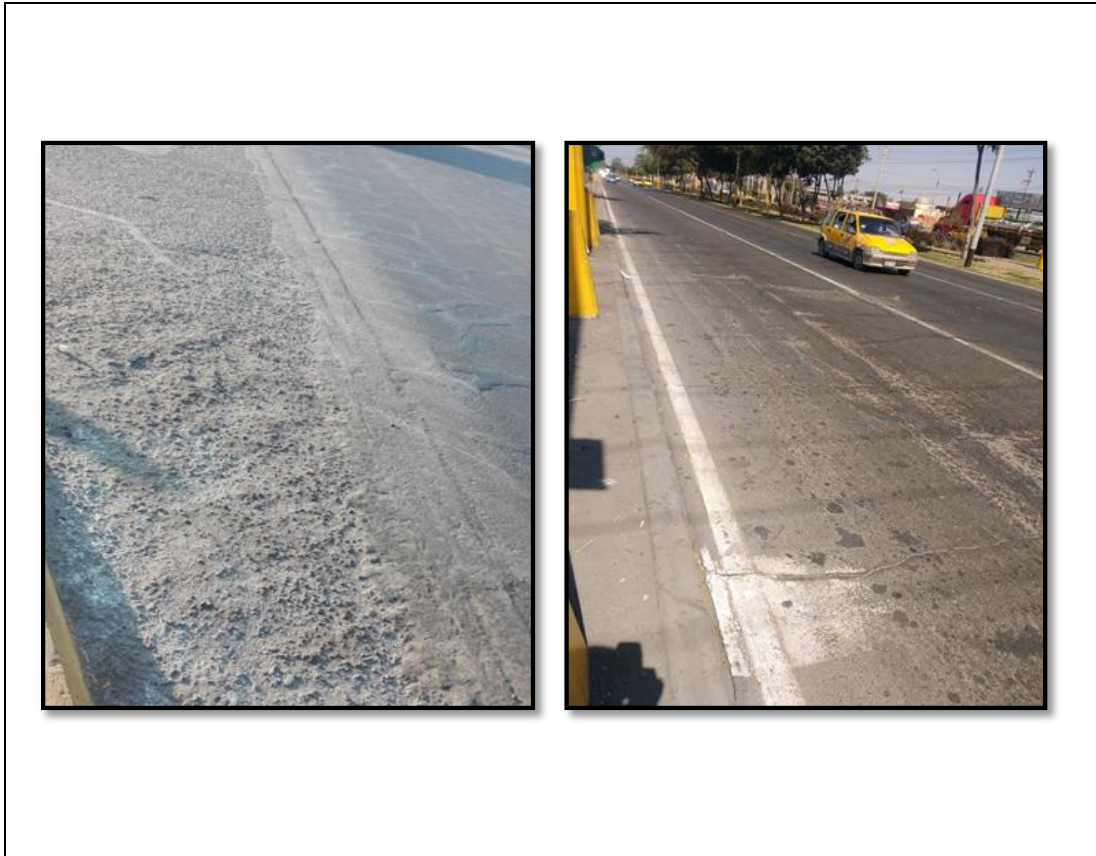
Estado actual del pavimento - Panamericana Sur – Ica.
